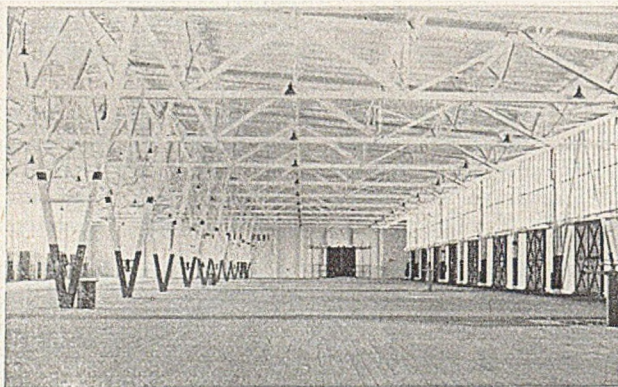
Schuppen 57, Holzfachwerkbinder mit Pfahlgründung.
